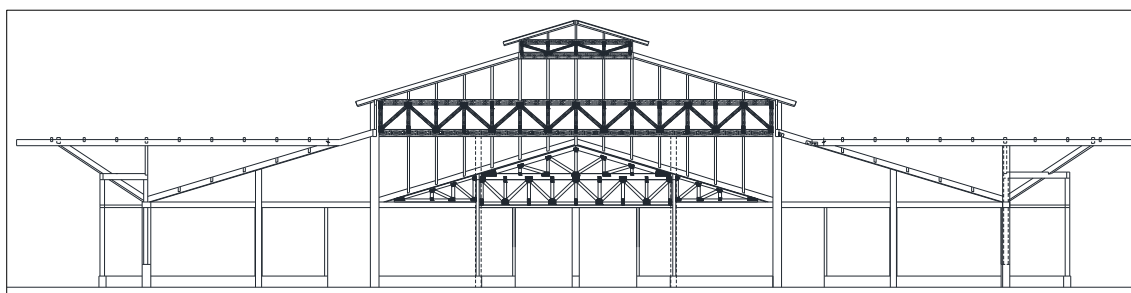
CORTE LONGITUDINAL DEL RESTAURANTE
